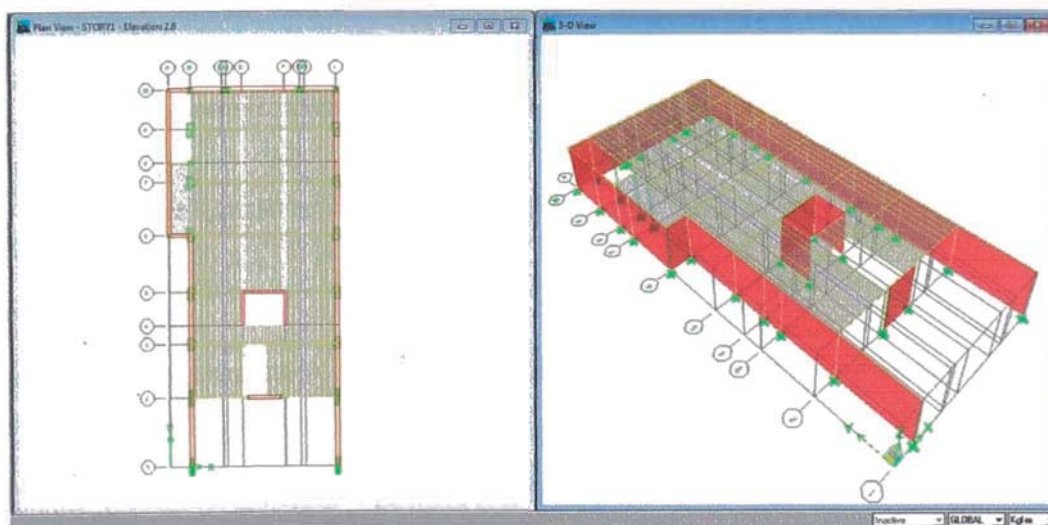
Disposición de los muros de corte en la base de la estructura
